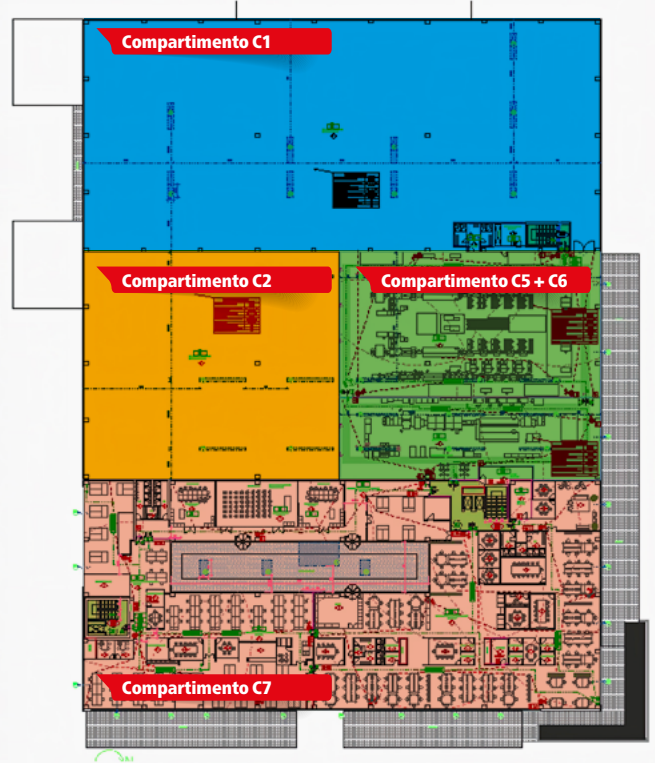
| Planimetria del primo piano e individuazione dei compartimenti
